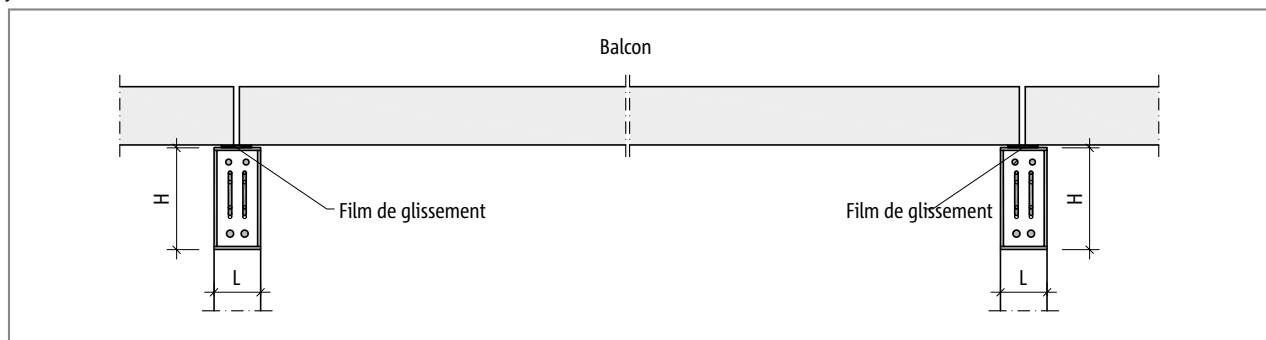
Schöck Isokorb® T Type B : Coupe ; Résistance à la fatigue grâce au film de glissement entre les dalles de balcon et les poutres en porte-à-faux
